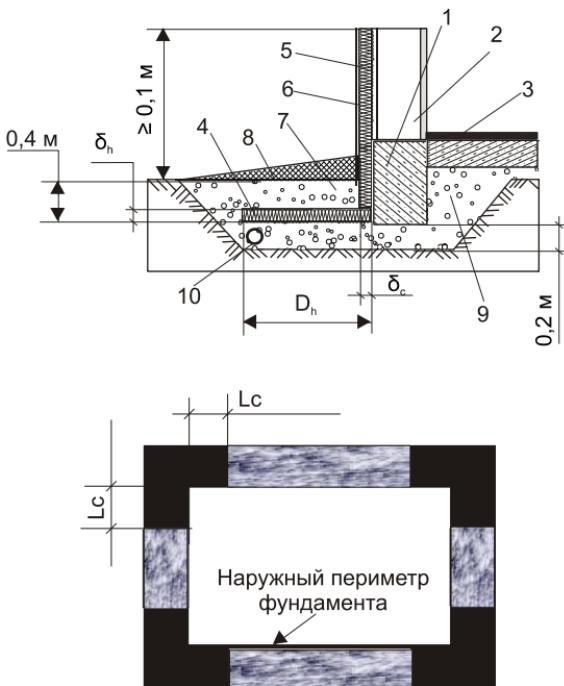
Схема укладки и параметры теплоизоляции в фундаментах отапливаемых зданий без теплоизоляции пола:
